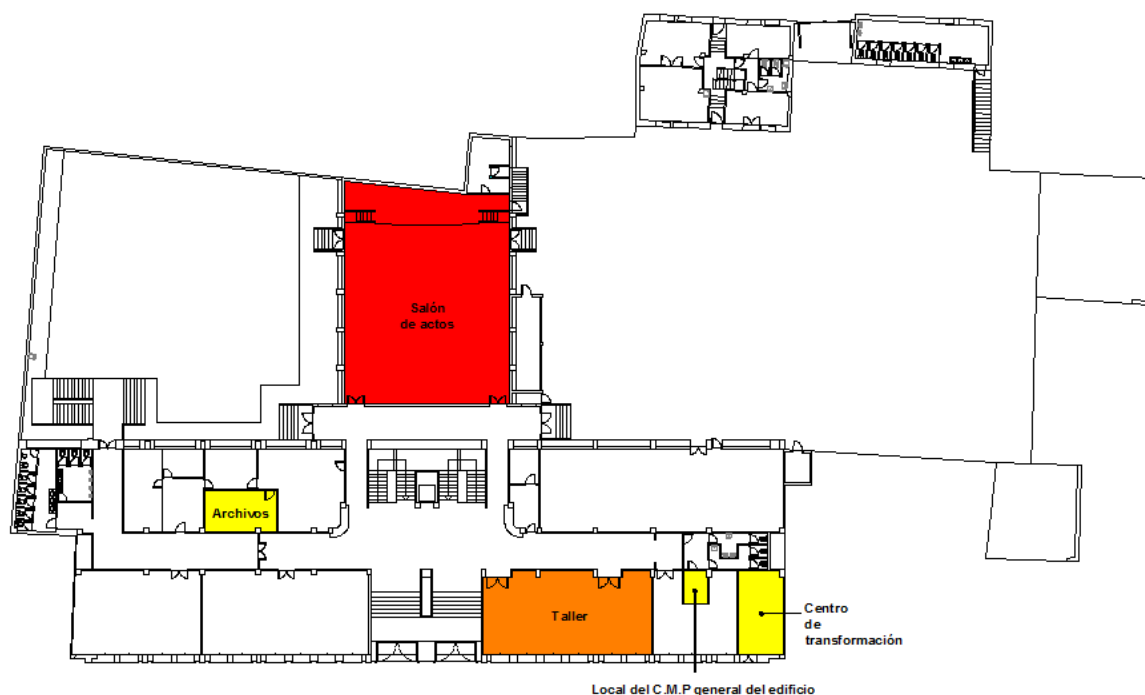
Locales de riesgo planta baja. Fuente: Elaboración propia.
